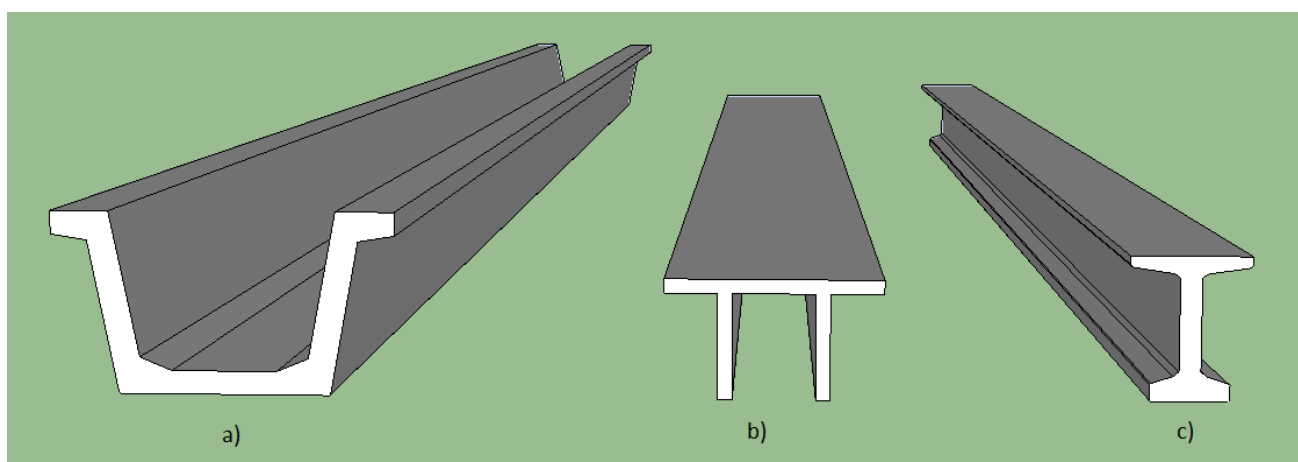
Secções correntes de vigas; a) Viga U ou viga caixão; b) Viga TT; c) Viga I
